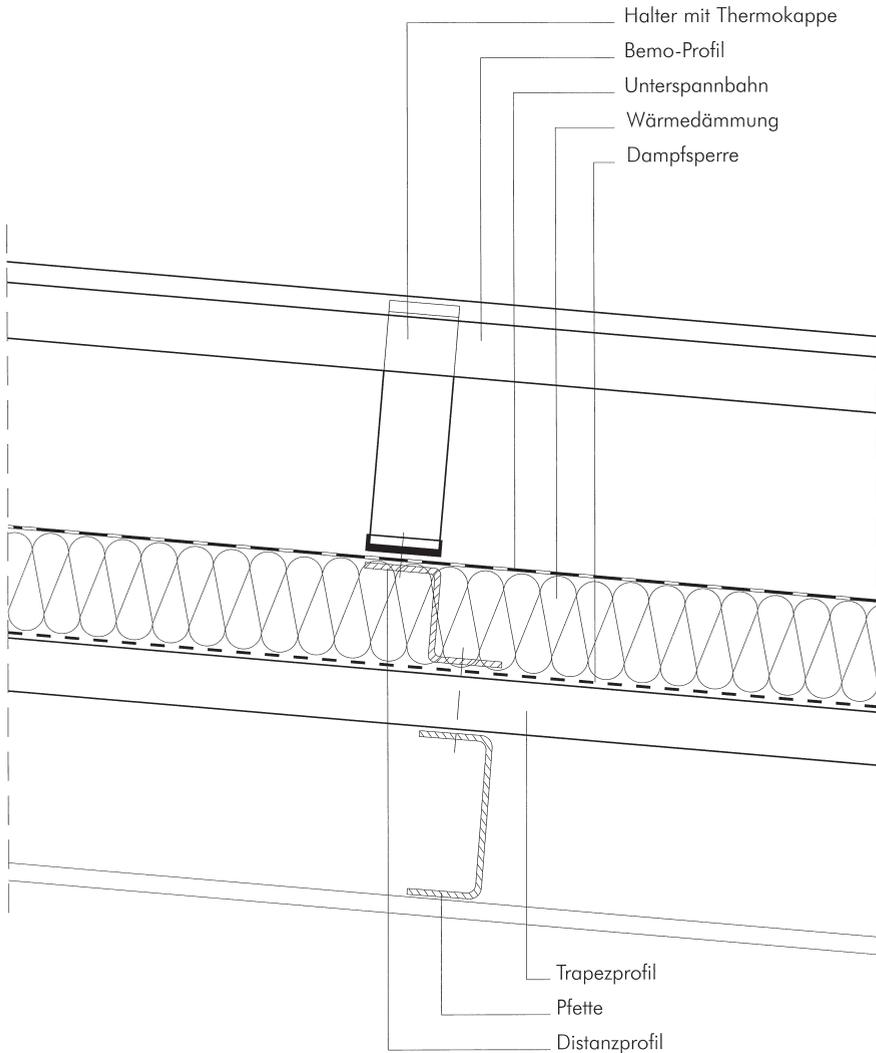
Dachaufbau beim zweischaligen wärmedämmten, belüfteten Metaldach
